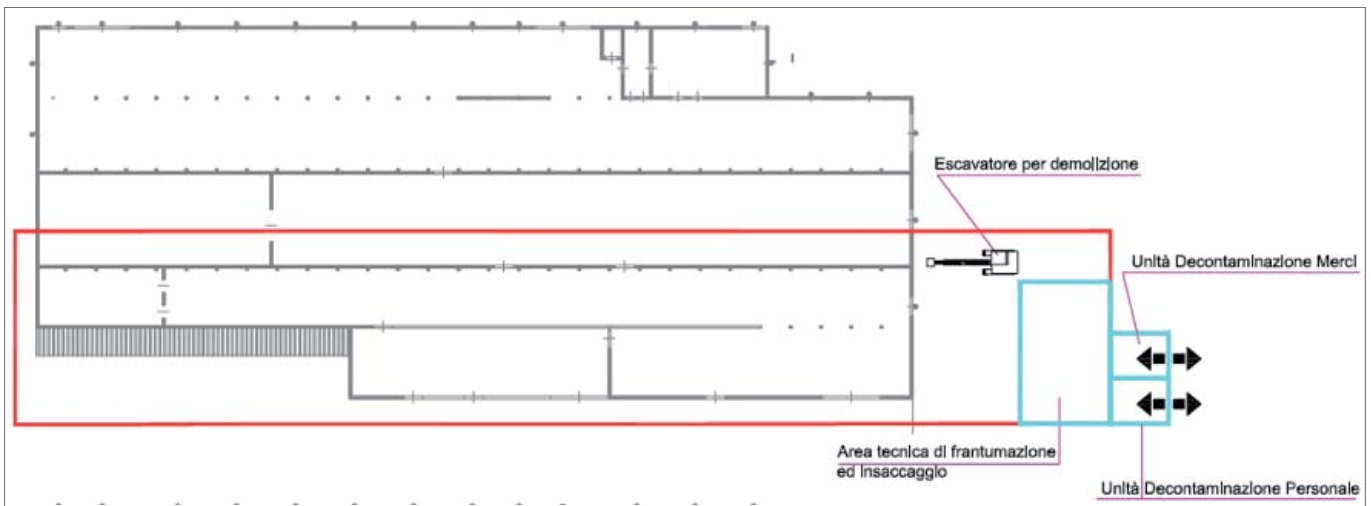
Rappresentazione planimetrica (in pianta) della camera confinata e delle strutture annesse
